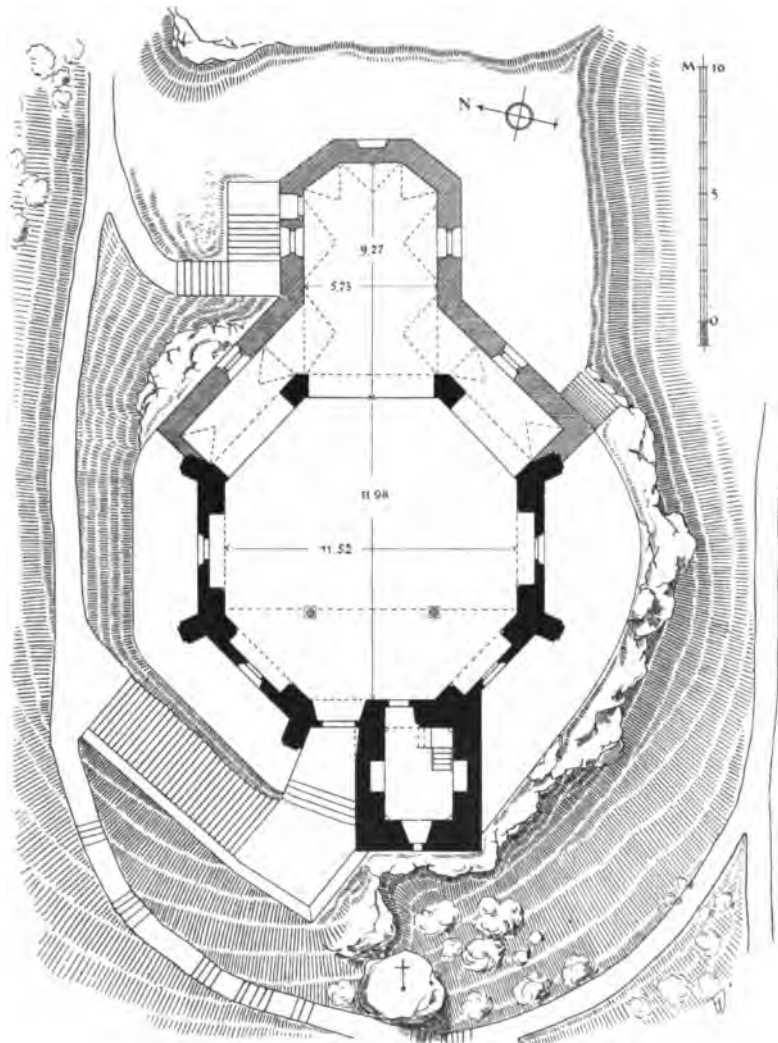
Breitenbrunn. Grundriß der Wallfahrtskirche St. Sebastian.
